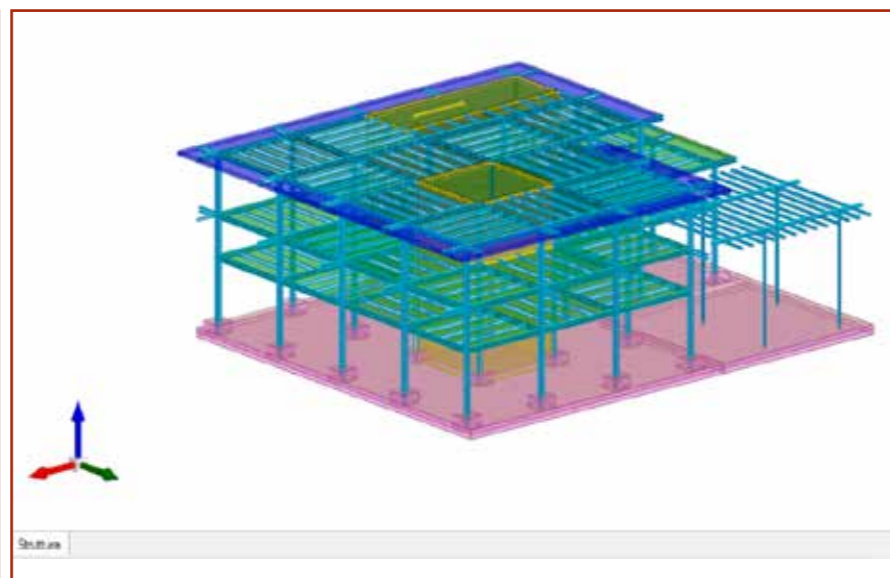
Rappresentazione generale della struttura - vista 4.png
